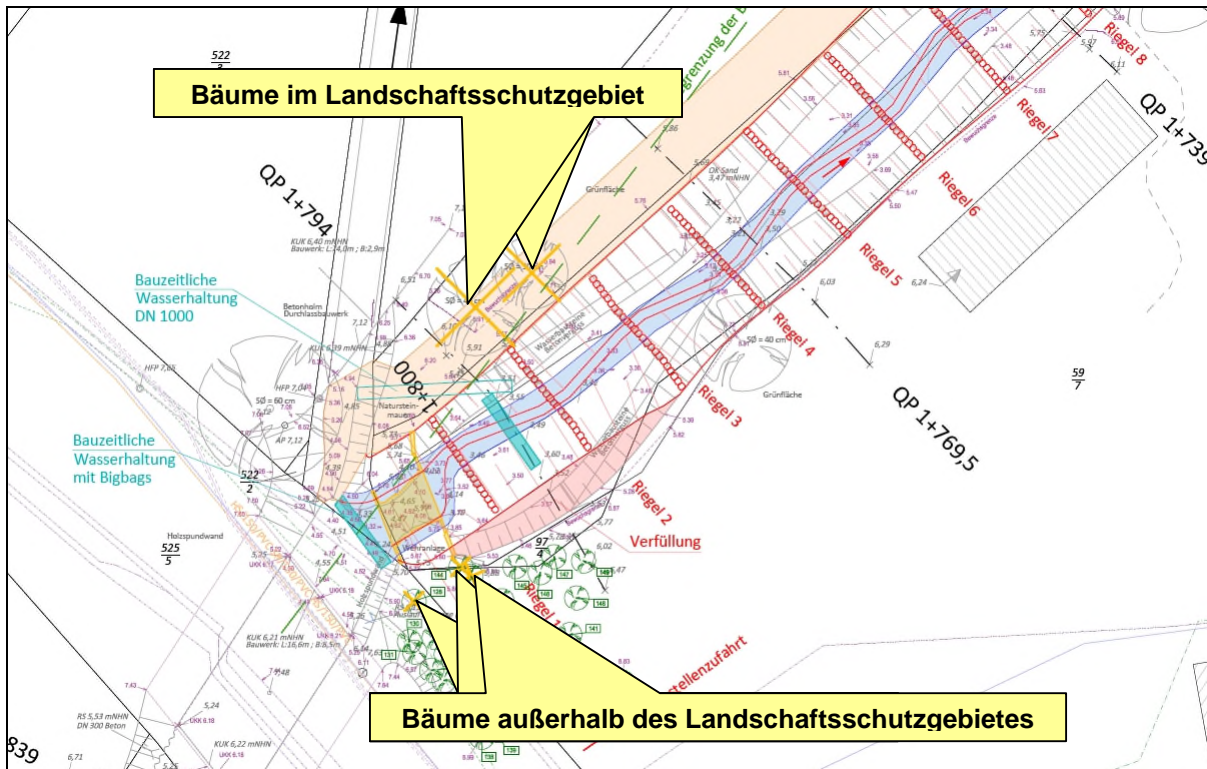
Lage der zu beseitigenden Einzelbäume (Auszug aus dem Lageplan Planung – GRIES & JÄCKEL 2021, eingenordet).
